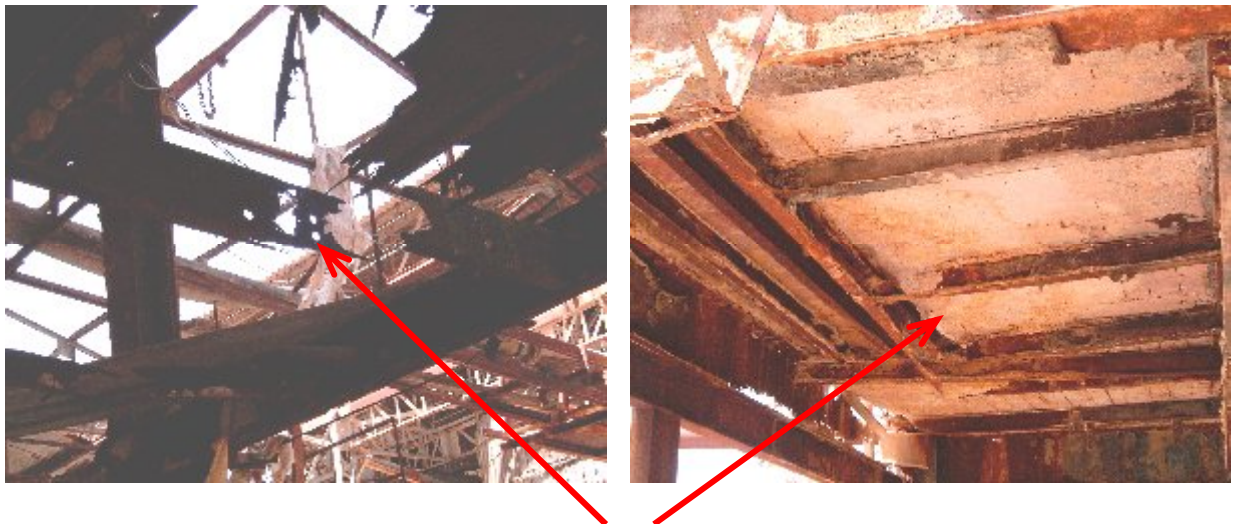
Autres dégradations dans les planchers et les poutres.
